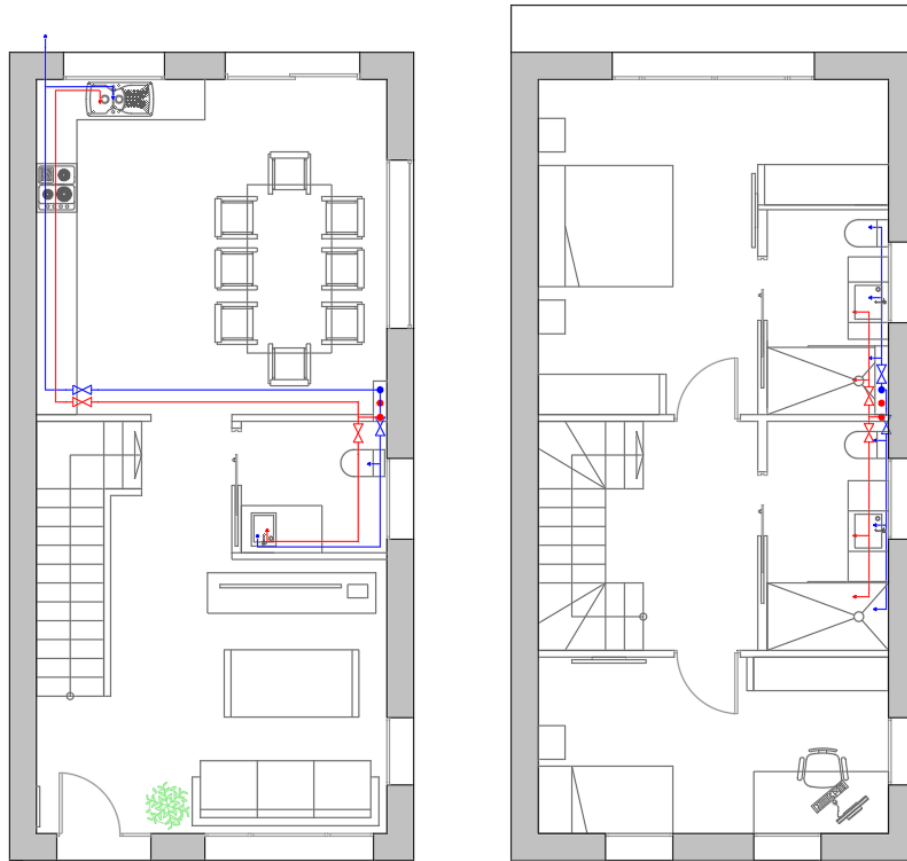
Esquema instalación agua fría y ACS planta baja y planta primera. 2019. Fuente propia.
